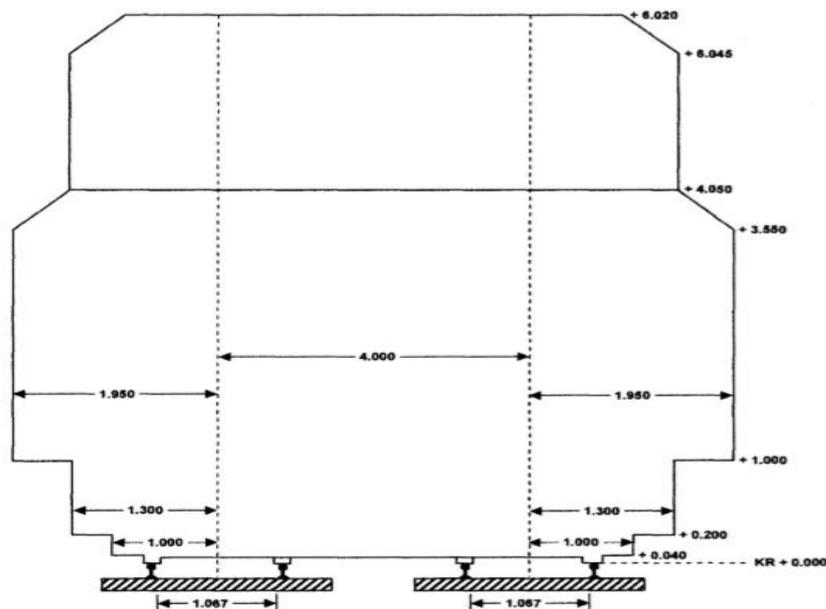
8 Ruang bebas jalan lebar sepur 1067 mm pada bagian lurus untuk jalur tunggal
